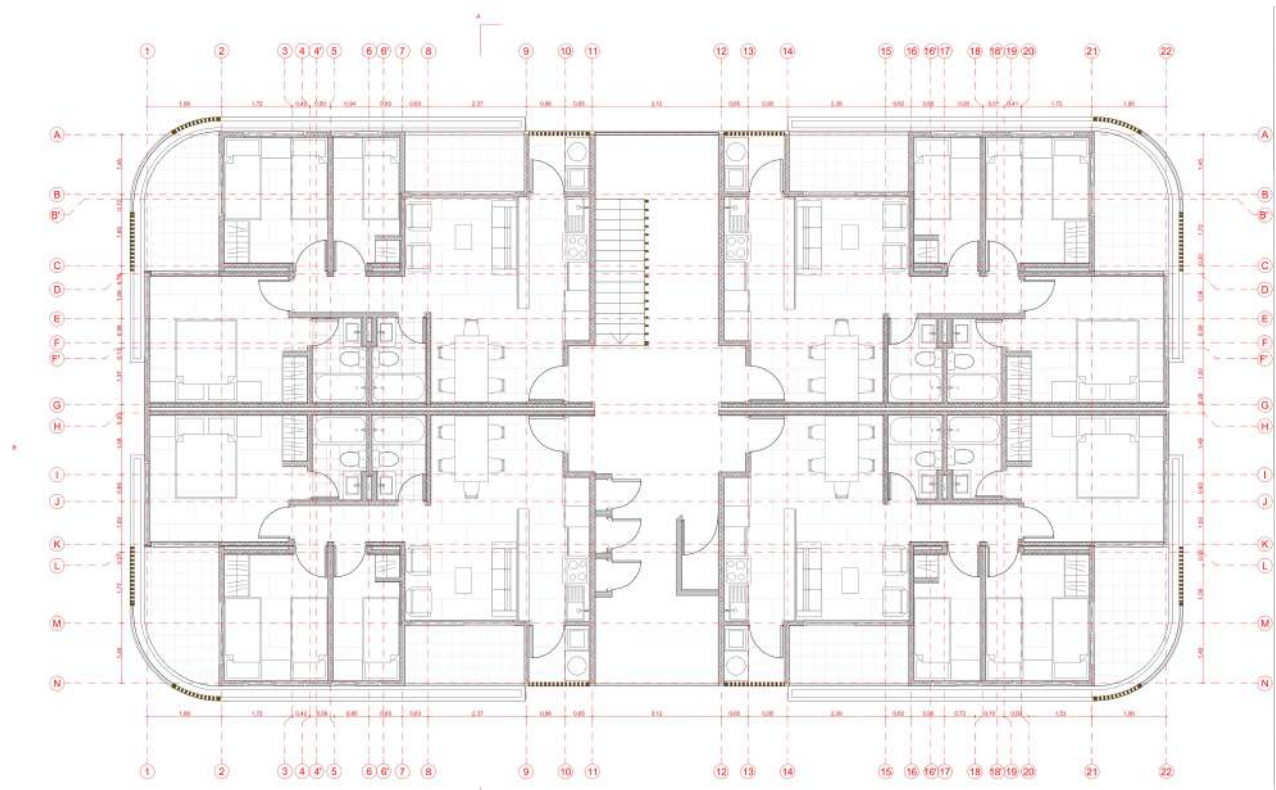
Planta de Arquitectura, Edificio Tipo 2.
